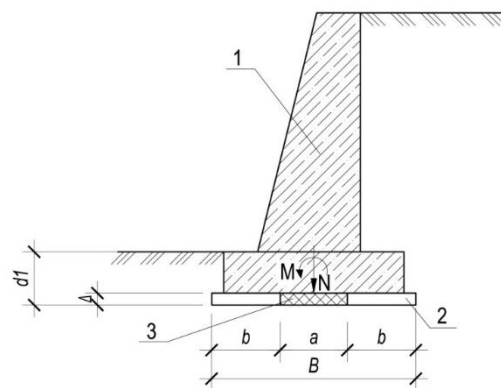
Фундамент масивної підпірної стіни: 1 – стіна; 2 – бетонна підготовка; 3 – вкладка з низькомодульного матеріалу
